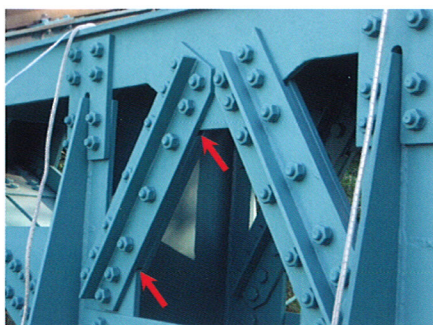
Dresdner Schwebebahn, Konstruktionsdetail
